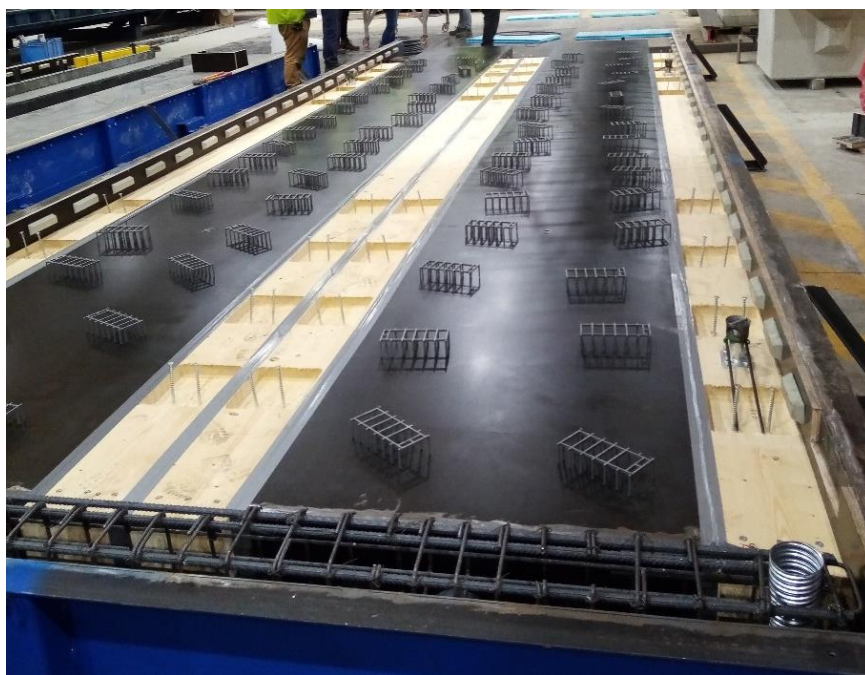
Produção do painel de laje - Vigas de madeira e fechos de bordo instalados
